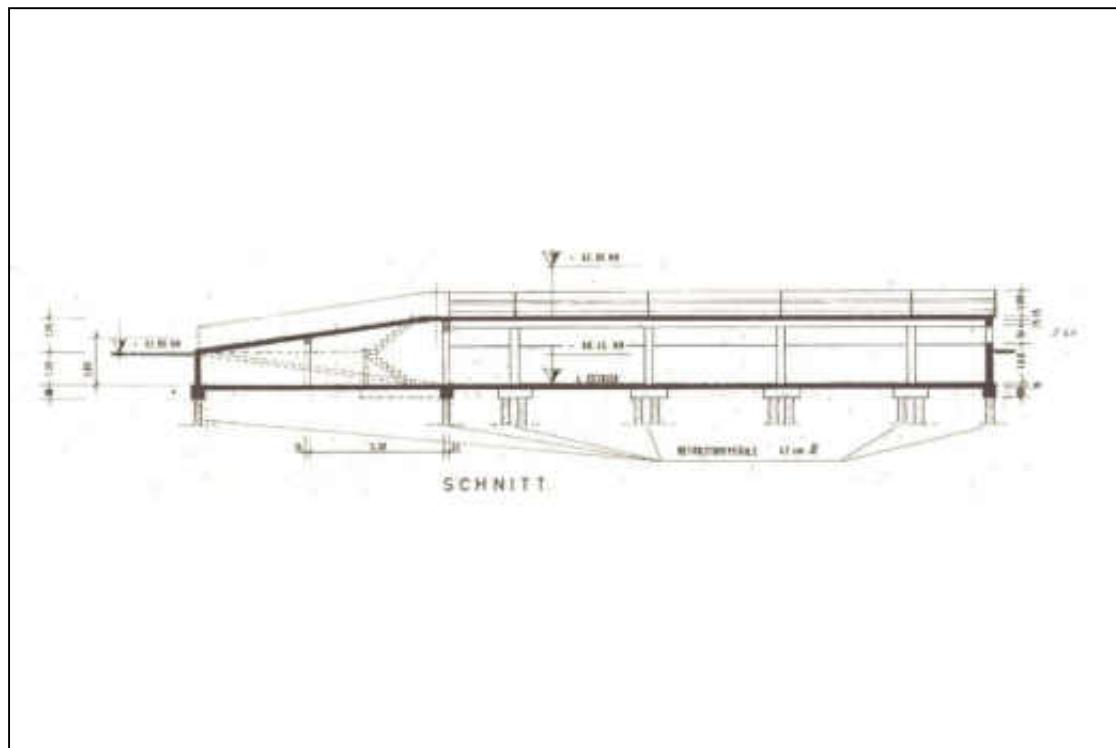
Schnitt durch das Parkdeck mit Tiefgarage
